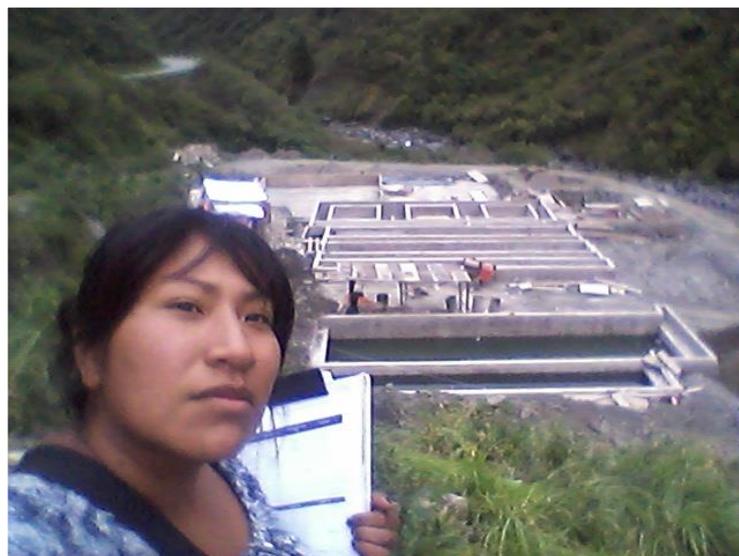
Planta de tratamiento de aguas residuales recién en construcción en la parte baja se encuentra el río Sandia donde desembocara.
